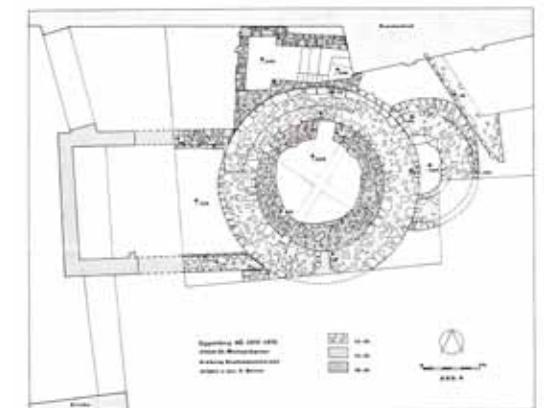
Grundriss des Untergeschosses. Melzer 1978. M 1:400.
